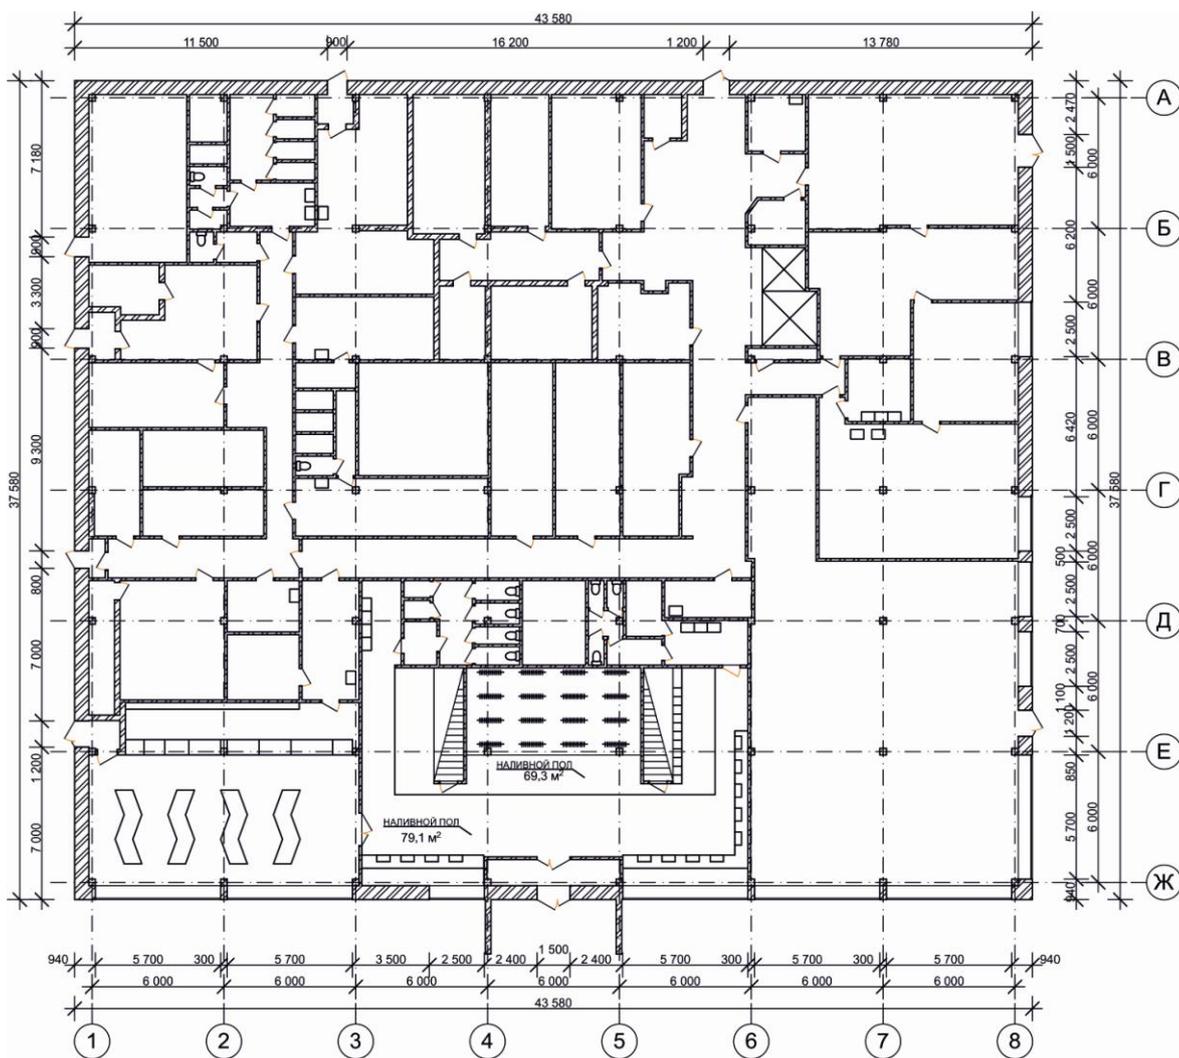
План пола 1го этажа с расстановкой оборудования
